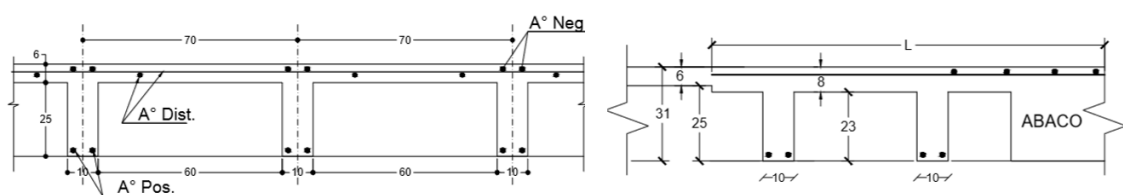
Detalles constructivos de la sección Losa Tipo [12]
